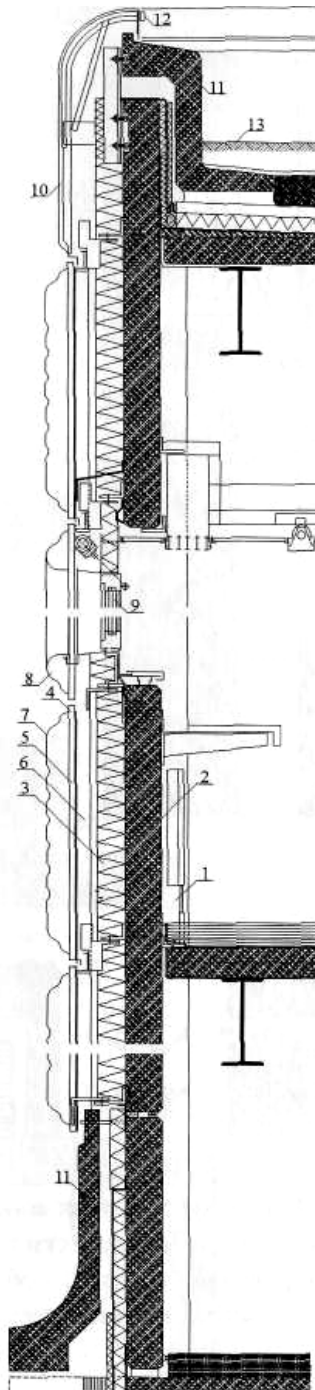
Наружная бетонная стена с металлической облицовкой; вертикальное сечение:
